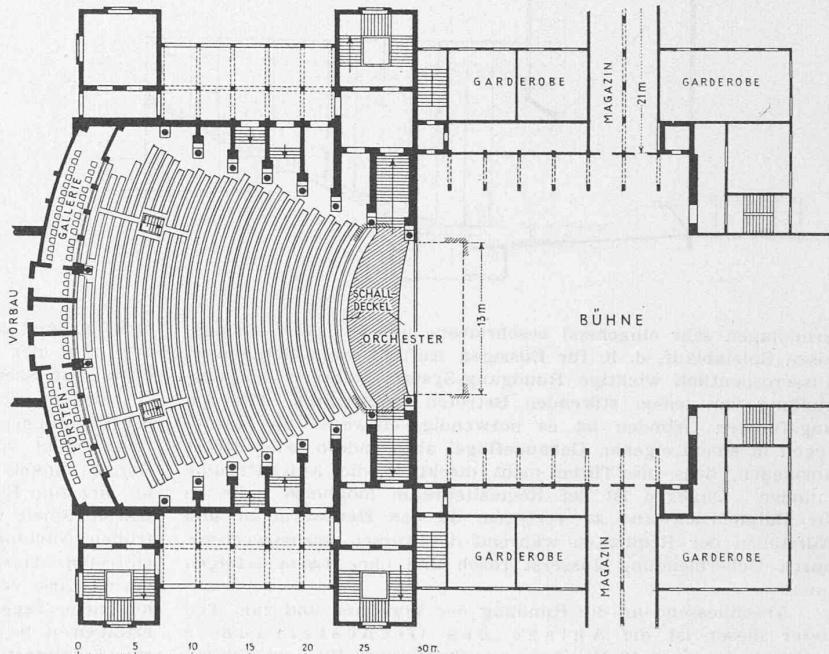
Das Bayreuther Festspielhaus mit ursprünglicher Treppenanlage. Grundriss 1:600
